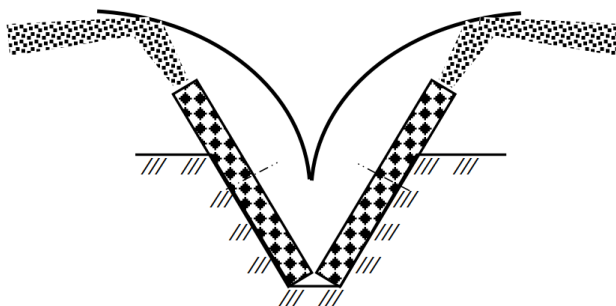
Схема двухфрезерного рабочего органа с отражающими щитами
